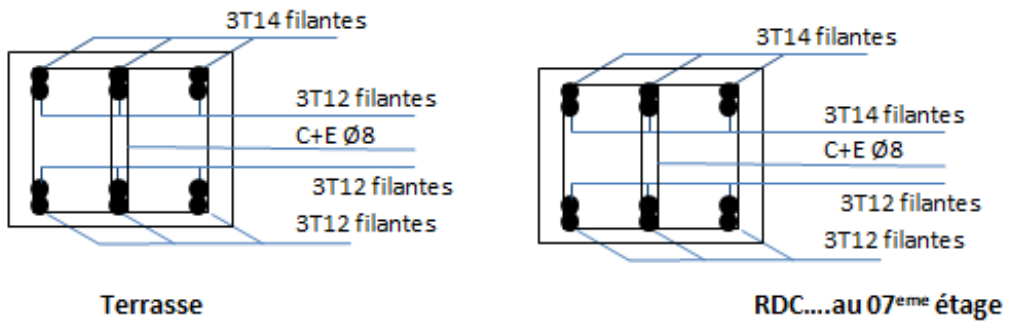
dessin de ferrailage des sections des poutres secondaire.
